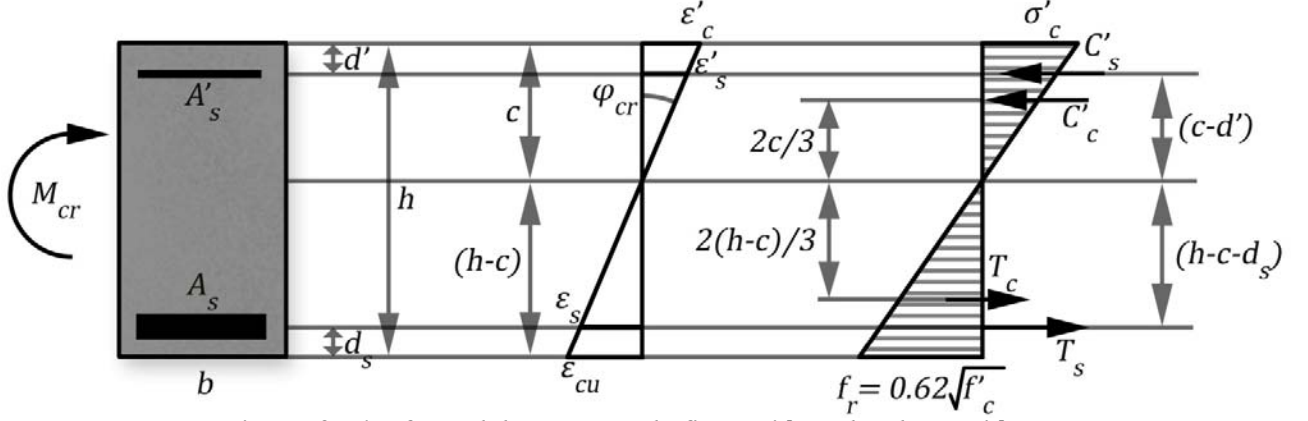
Efecto del momento de fisuración sobre la sección.
